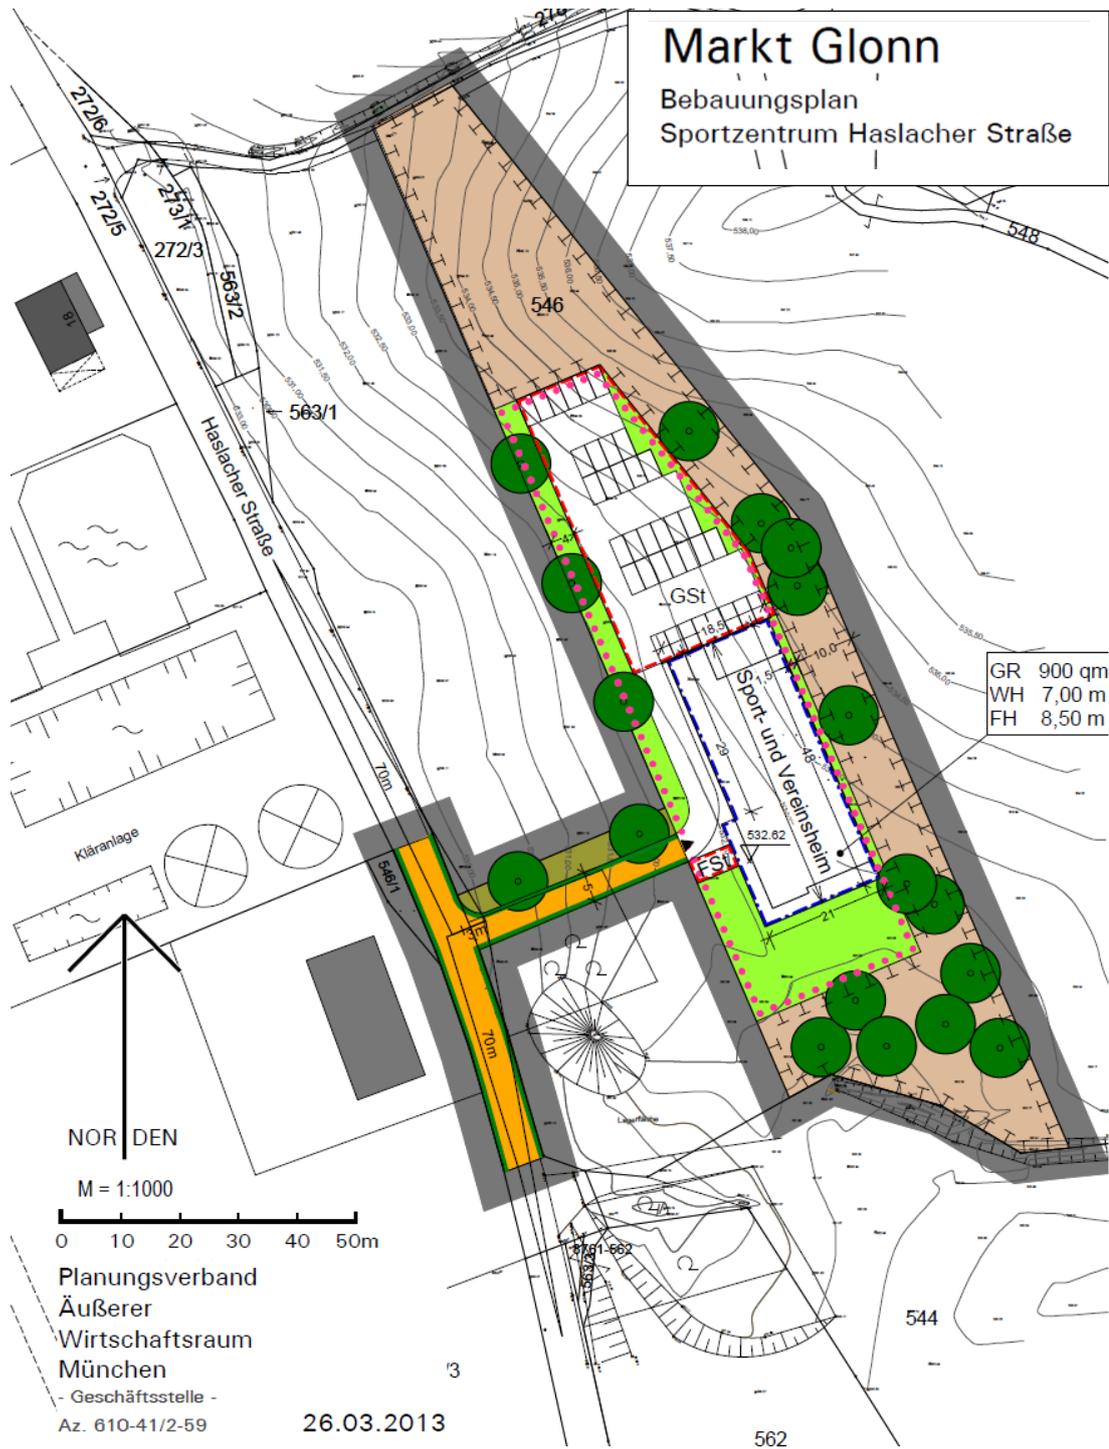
Bebauungsplan „Gemeinbedarf Sportzentrum Haslacher Straße“, ohne Maßstab
